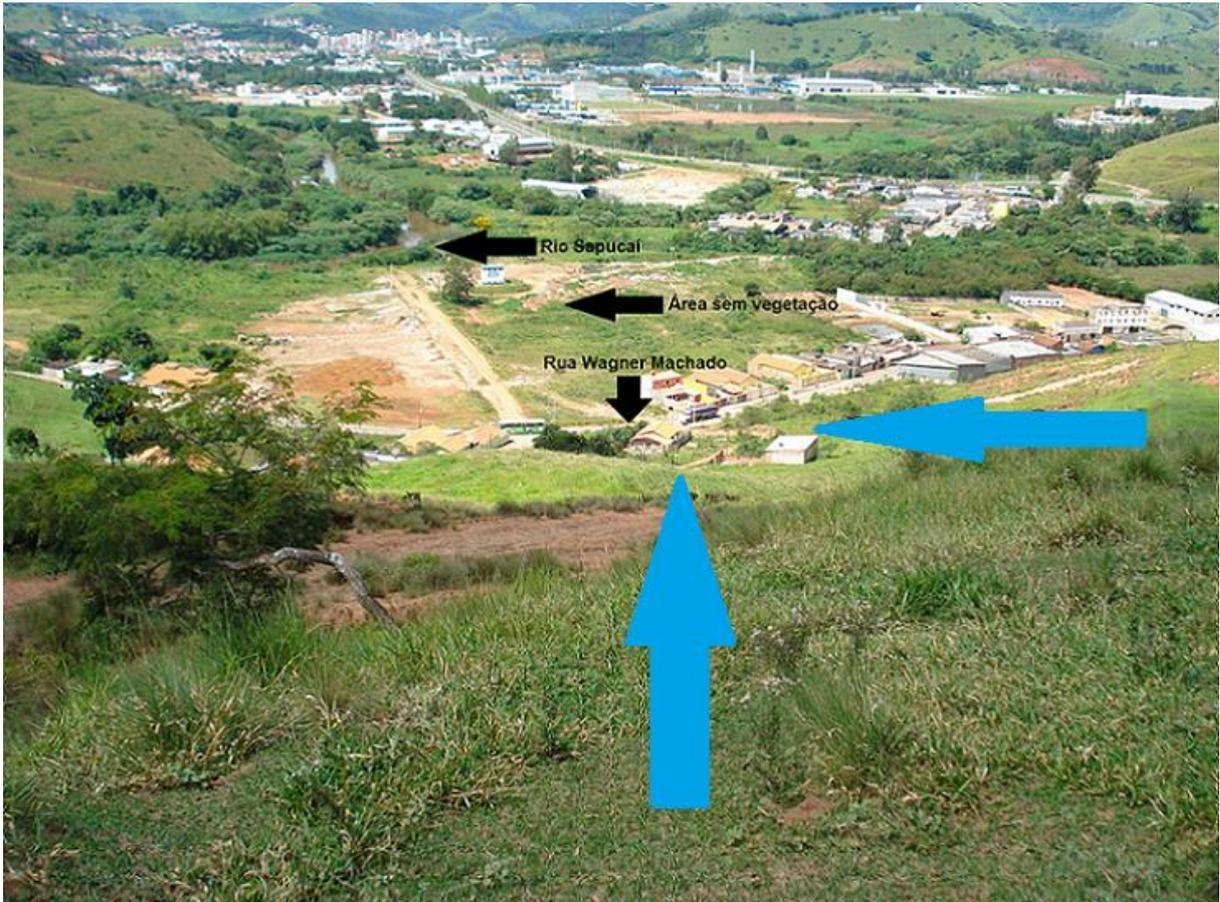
7. Locais afetados pelo escoamento pluvial do Loteamento Paraíso: Avenida Wagner Machado, na parte inferior do loteamento; área sem vegetação, situada em frente ao loteamento; e Rio Sapucaí, próximo ao loteamento. Setas azuis indicando a direção do escoamento.
